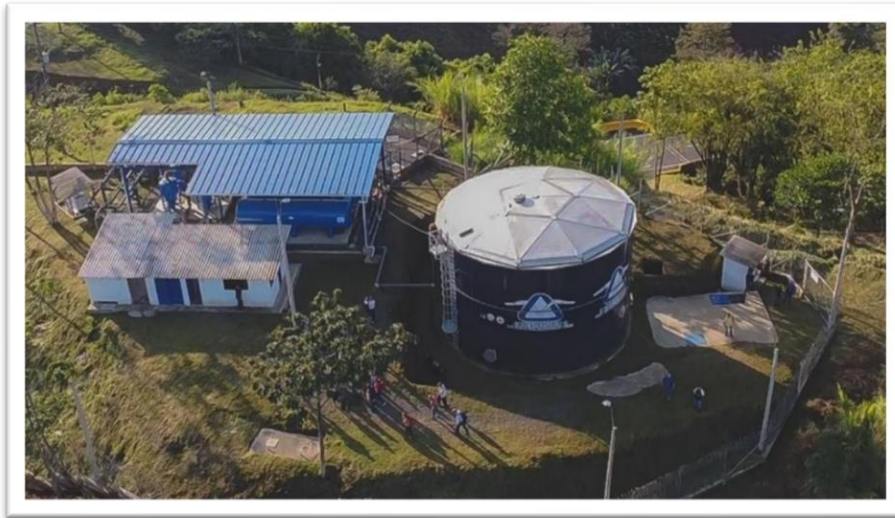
ServiCiudad ESP, Sede Planta de Tratamiento Villasantana, Pereira.
